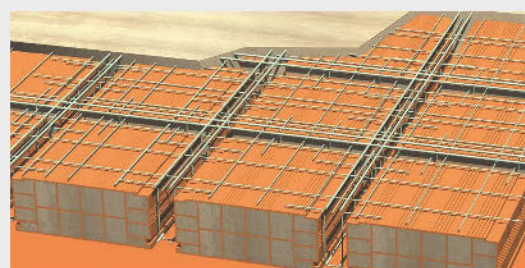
Forjado reticular con nervios hormigonados "in situ"
